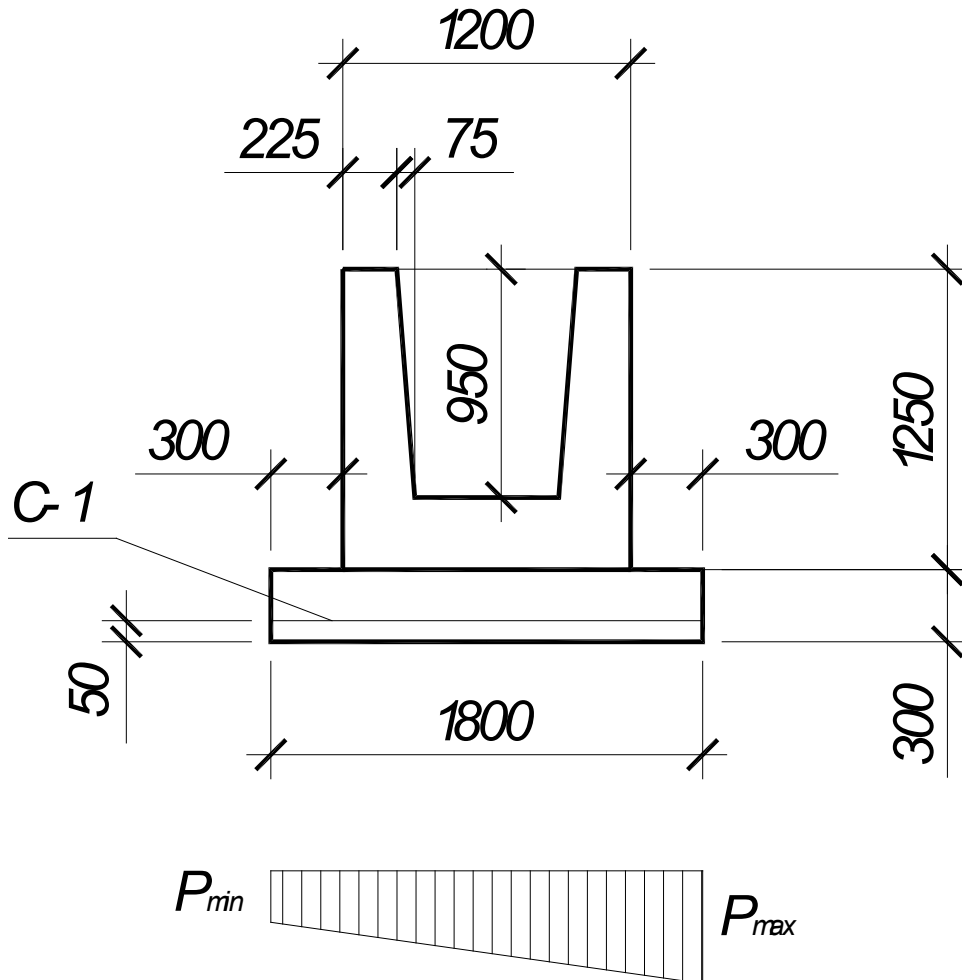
До визначення перерізу арматури плиткової частини фундаменту
